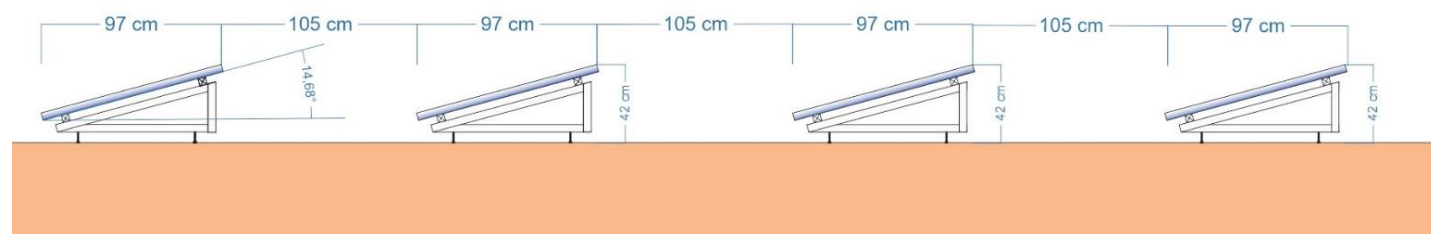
Konstrukcja kotwiona do konstrukcji dachowej
